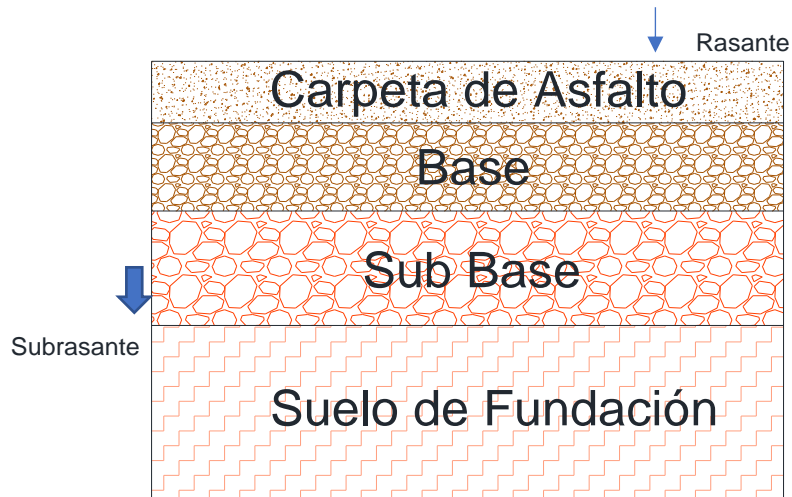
Sección transversal típica de la estructura un pavimento flexible.
